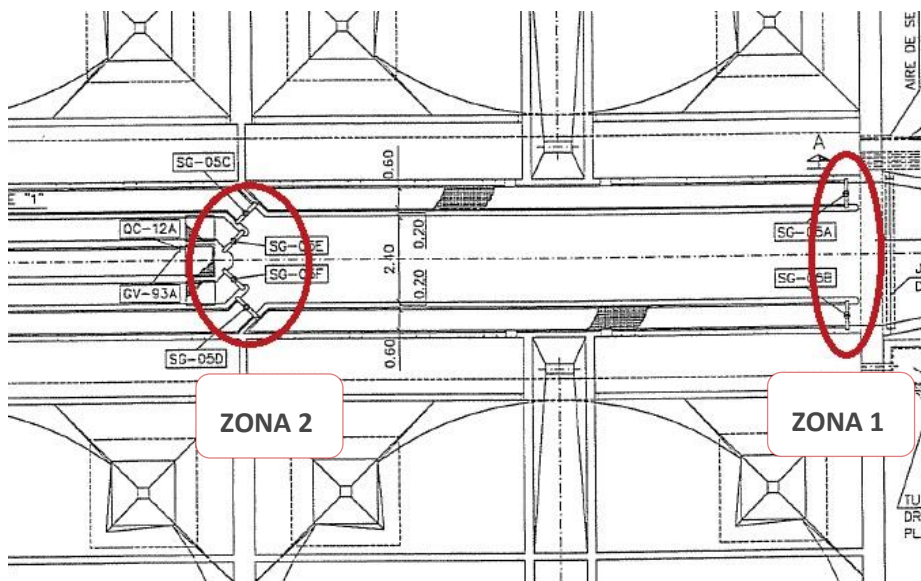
Planta de los canales de reparto a decantación primaria.
